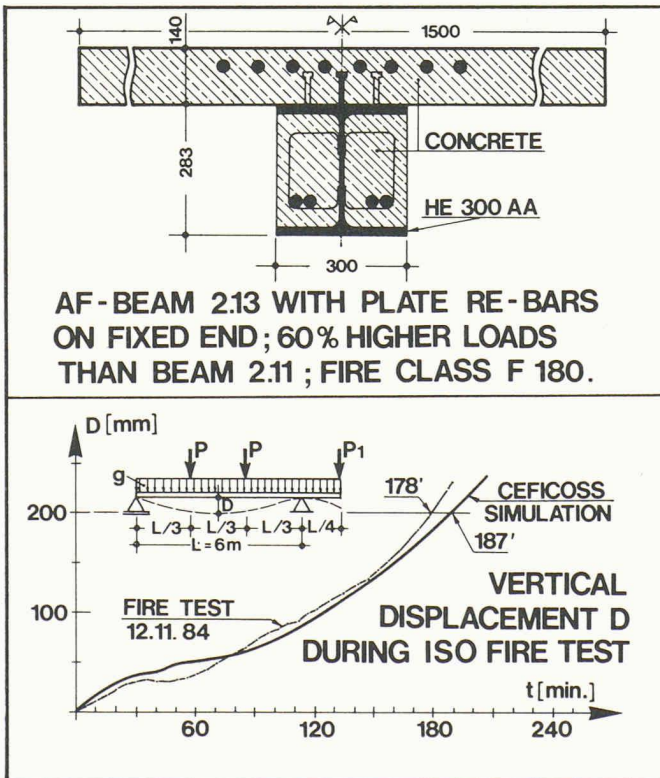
Flèche mesurée et calculée à mi-portée d'une poutre mixte appuyée-encastree.
